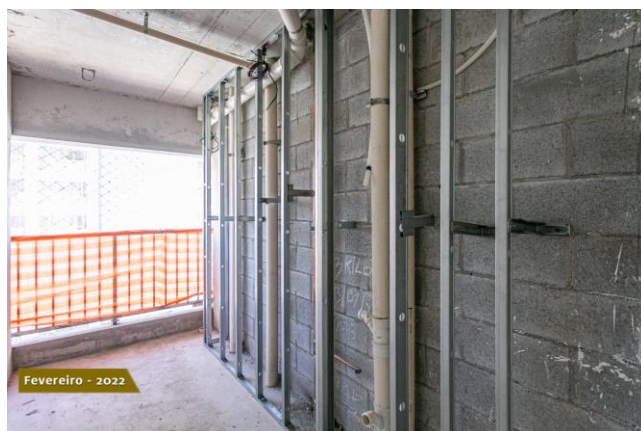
Estrutura de dry wall em parede com tubulação hidráulica
